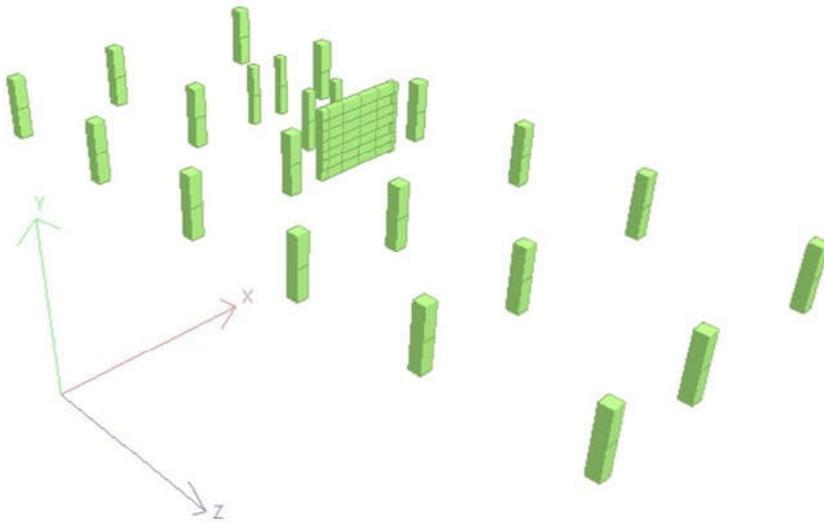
Render hasil potongan berat bangunan lantai 5
